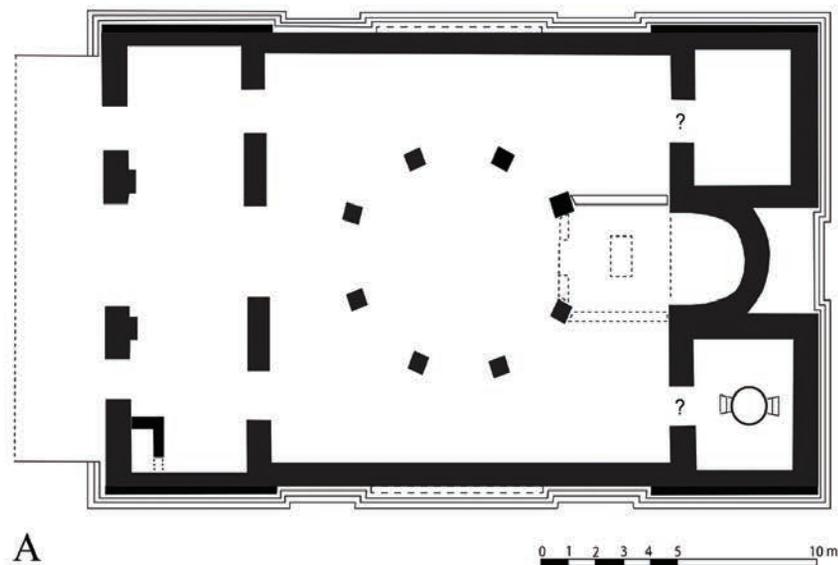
Planimetria schematica e ricostruzione ipotetica della chiesa orientale.
